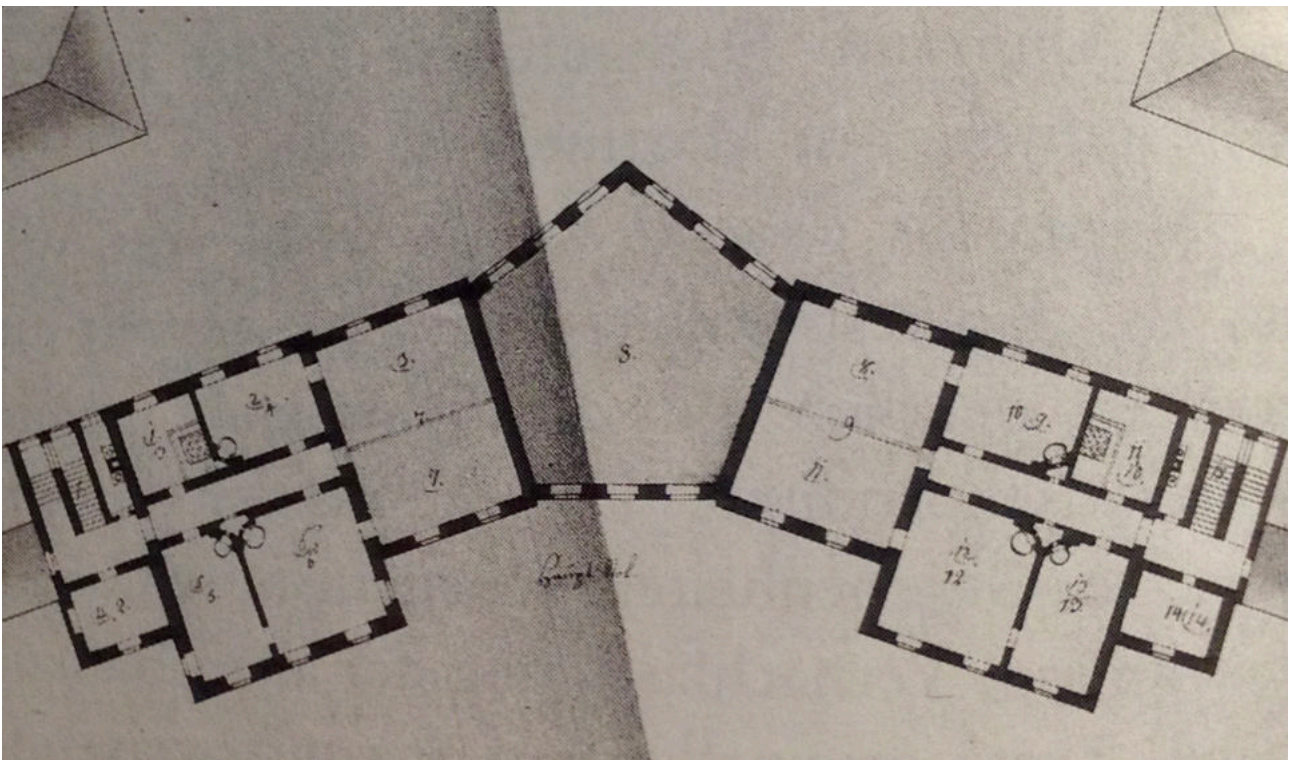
Grundriss des Gartenpalais Obizzi, Domenico Martinelli, um 1694
